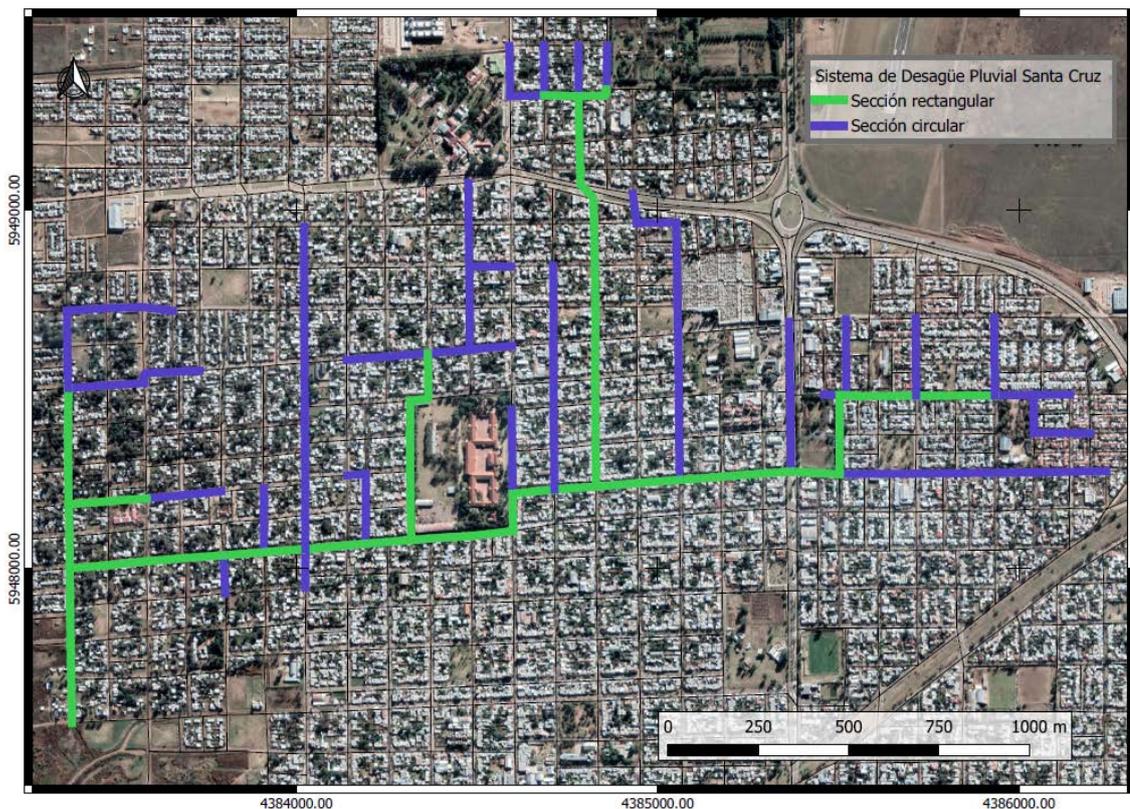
Sistema de Desagüe Pluvial Santa Cruz. Tipo de secciones
